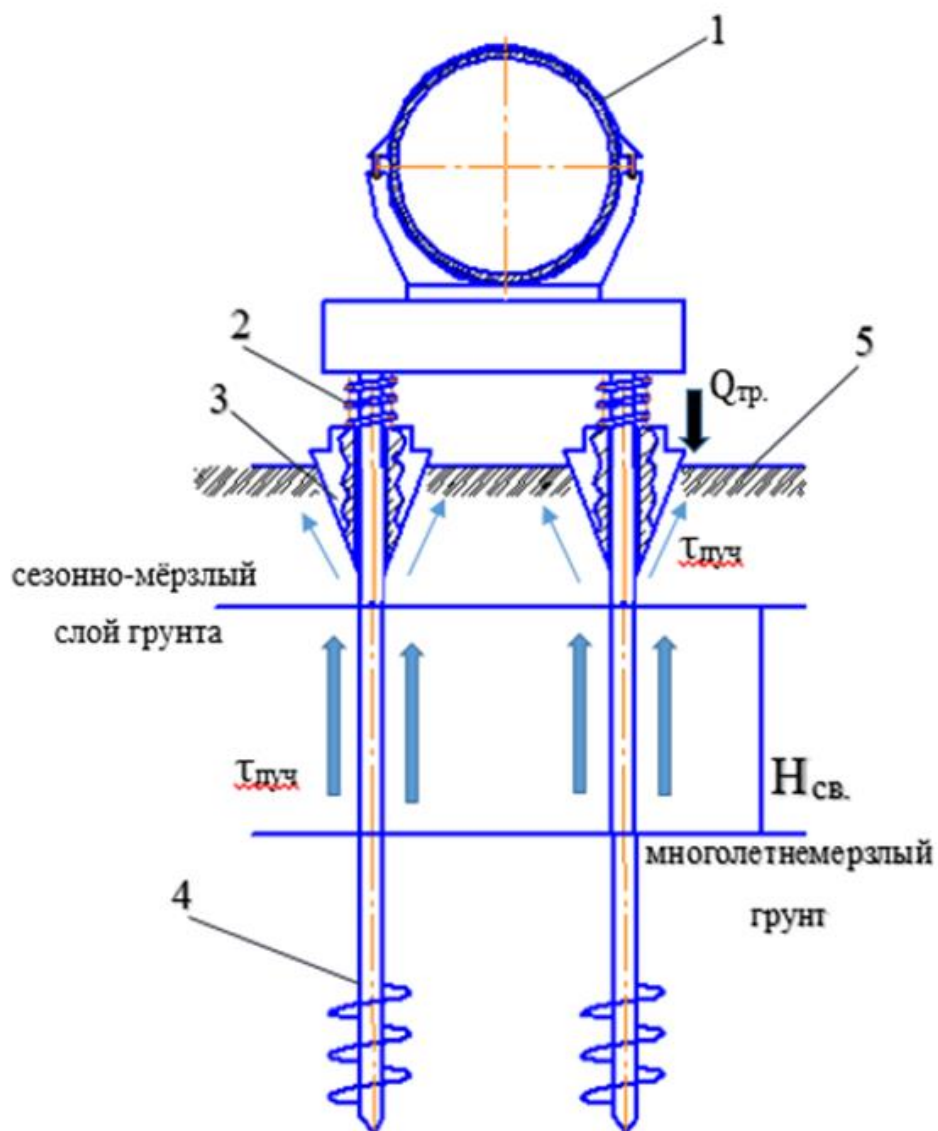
Схема разработанной конструкции для обеспечения проектного положения трубопровода, сооруженного в многолетнемерзлых грунтах: 1 – трубопровод; 2 – демпфер; 3 – клин опоры; 4 – винтовая свая; 5 – пучинистый грунт
